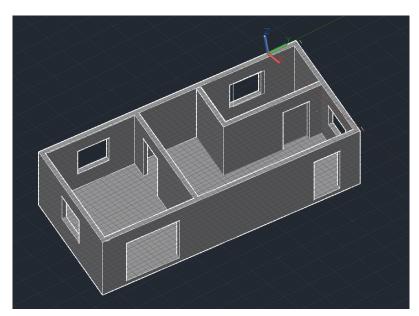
Le plan de la maquette en 3D [AutoCAD]
